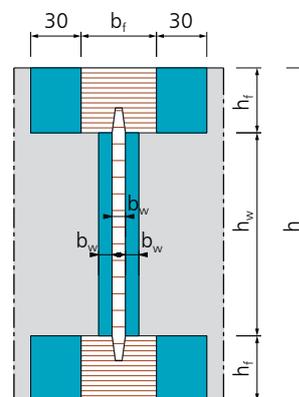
Wirksame Querdruckfläche bei voller Lagerung [3]
